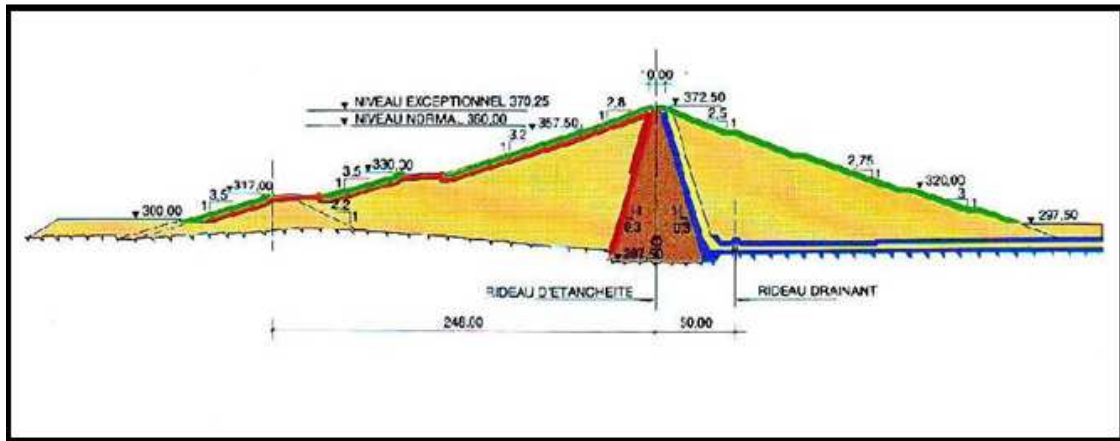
Coupe en travers du barrage de Hammam Debagh (d'après A.N.B.T.)
